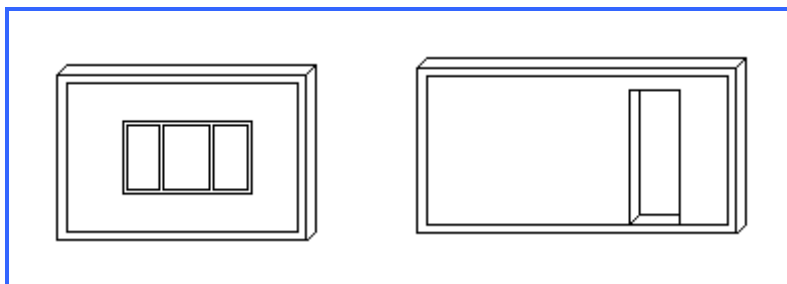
Збірні залізобетонні стінові панелі для громадських і житлових будівель: а) зовнішня; б) внутрішні.
